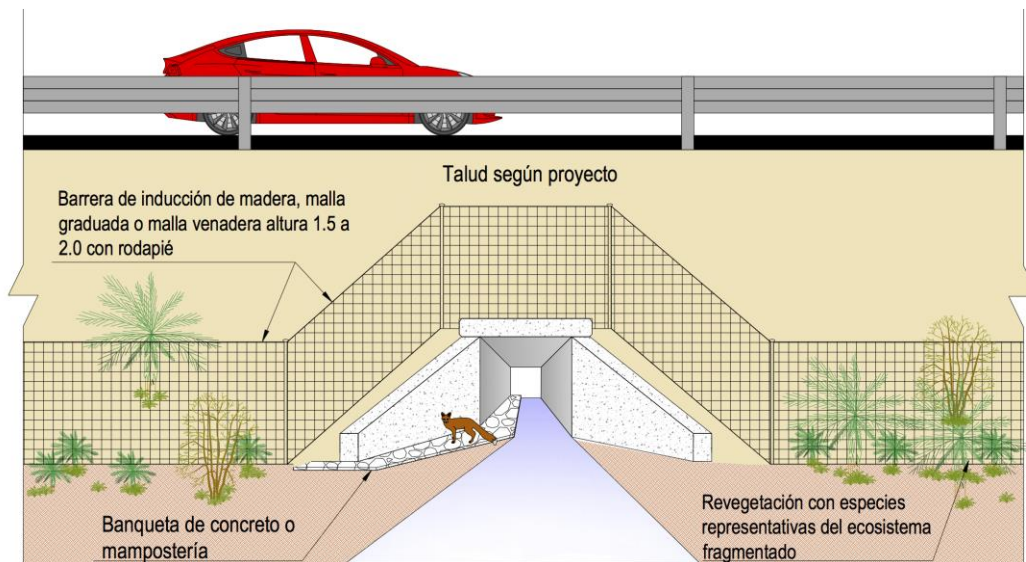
Ejemplo de obra de drenaje con banquetas laterales.
